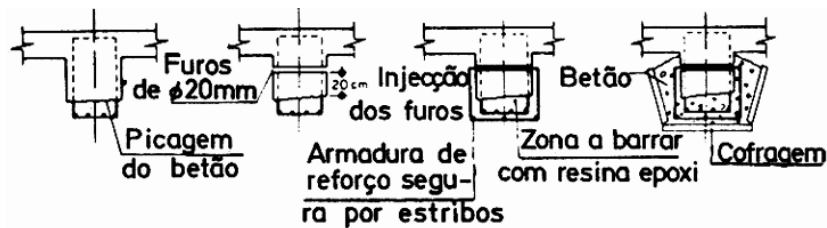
Reforço de uma viga à flexão com recurso a nova armadura embebida na viga pré-existente (12).
